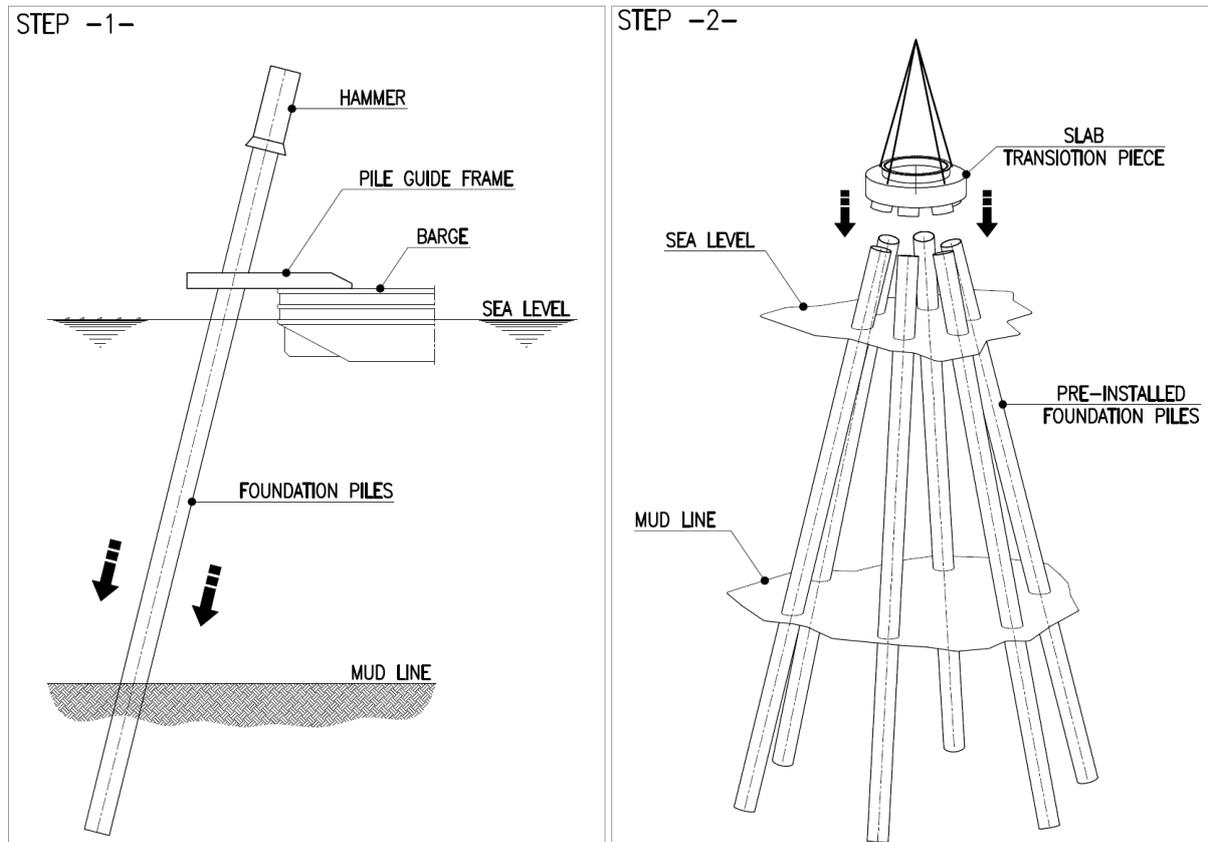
a sx, Fase 1- installazione pali con guida su HLV. A dx, Fase 2- installazione conglomerato in calcestruzzo e saldatura pali
